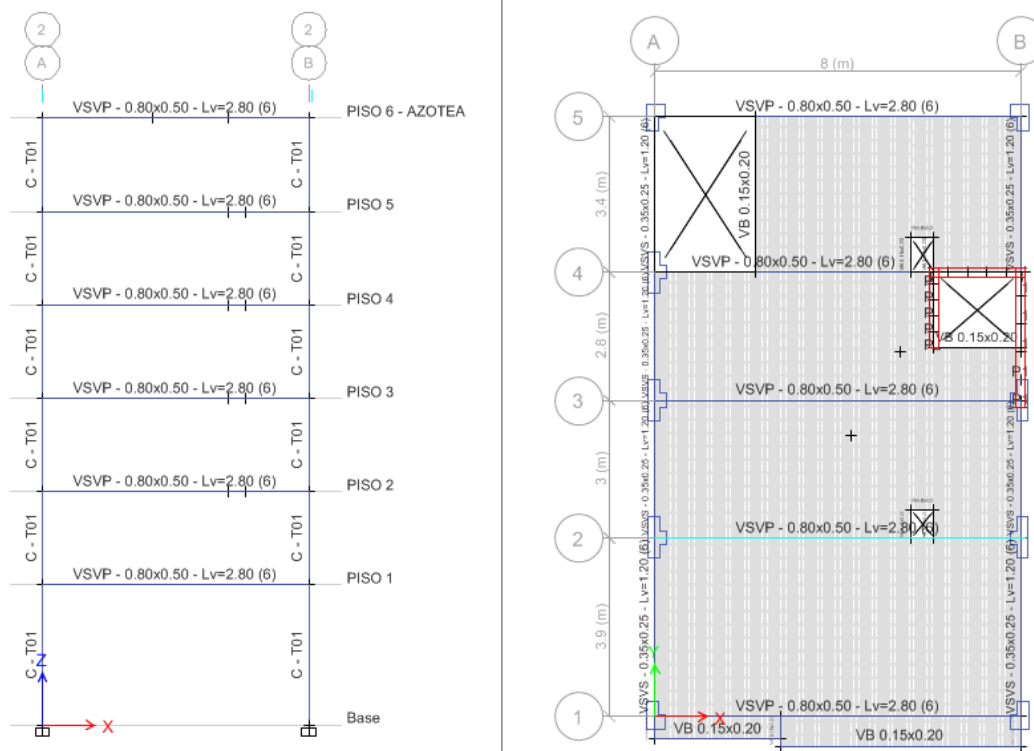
24 Vista en elevación y planta típica de la estructura del pórtico principal 2 - CASO N°06.
